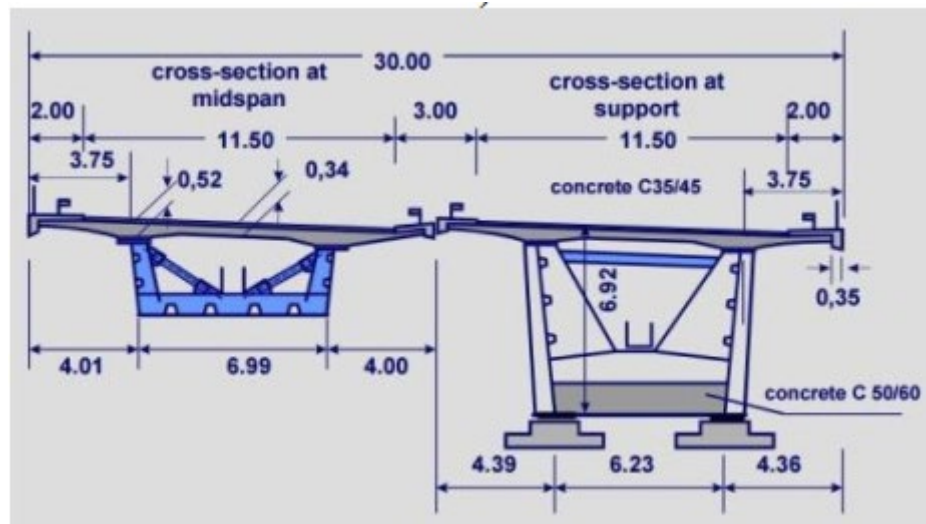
Переріз прогонової споруди з однією балкою коробчастого типу на опори (cross-section at midspan) та прогоні (cross section at supports).
